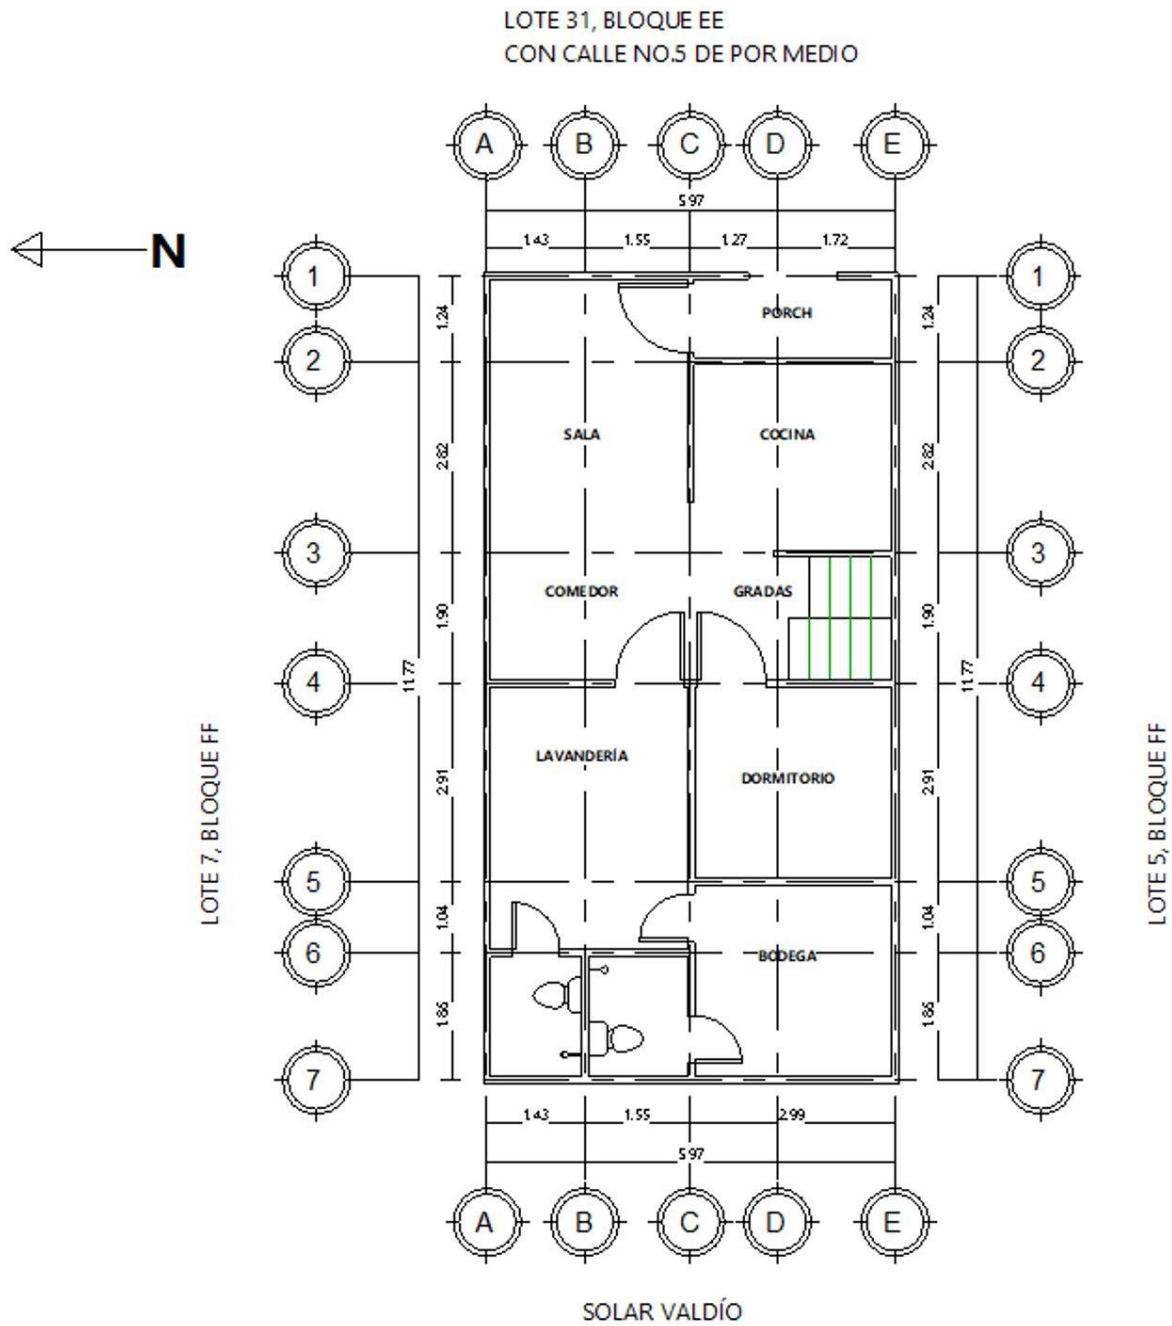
Planta arquitectónica del primer nivel de la vivienda
